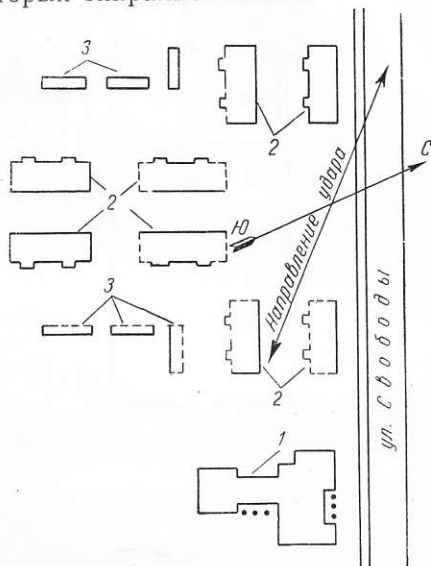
Схема генерального плана участка второго железнодорожного городка (пунктиром показаны разрушенные стены)
